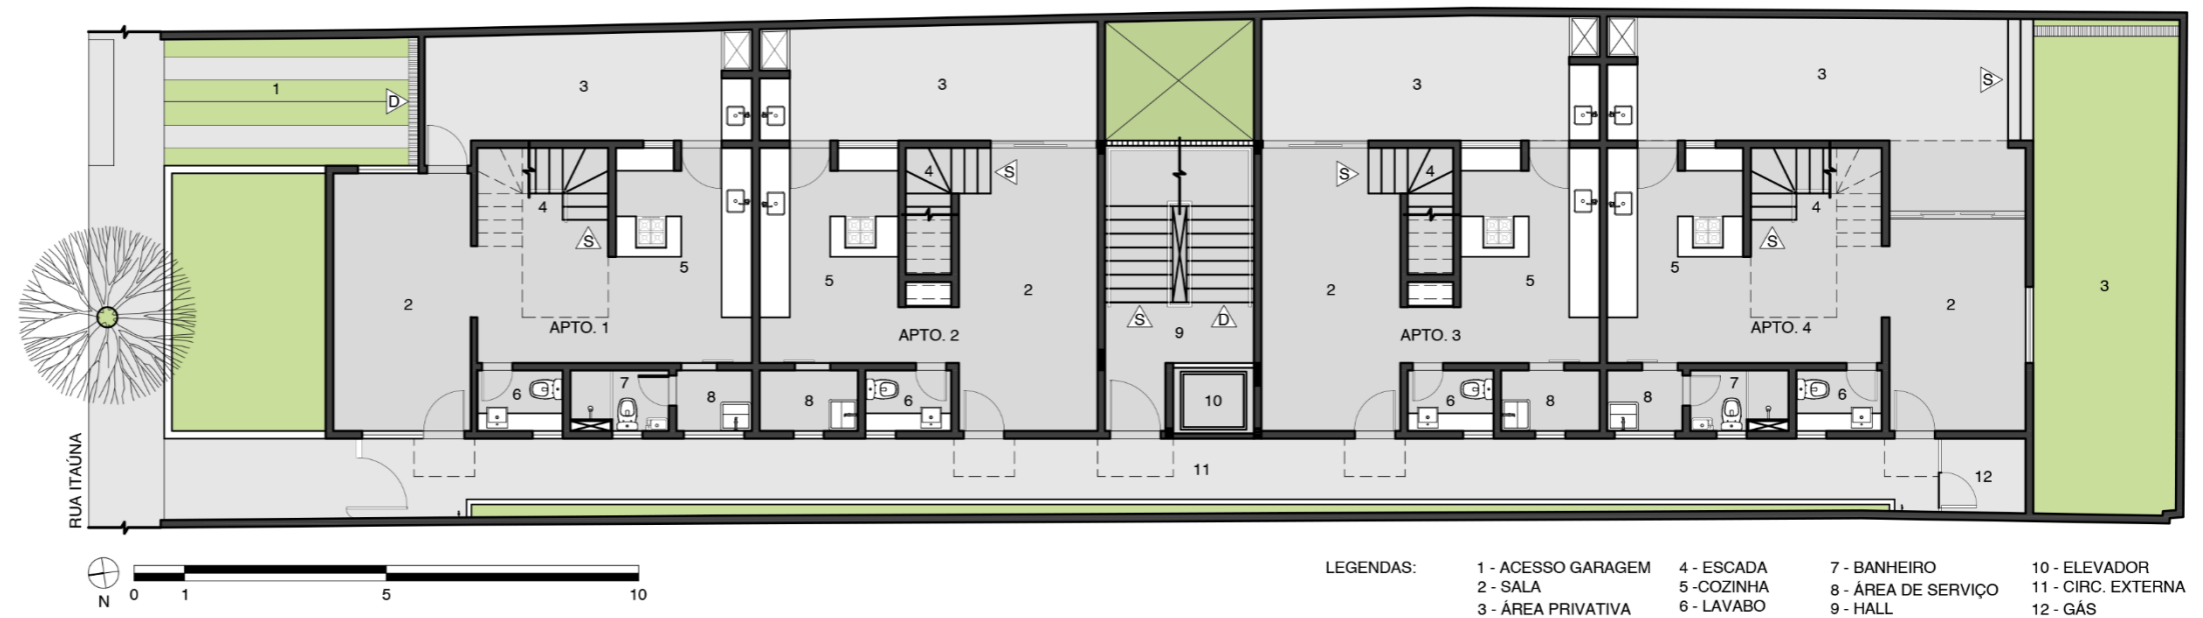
Planta do pavimento térreo do Residencial Zíder
